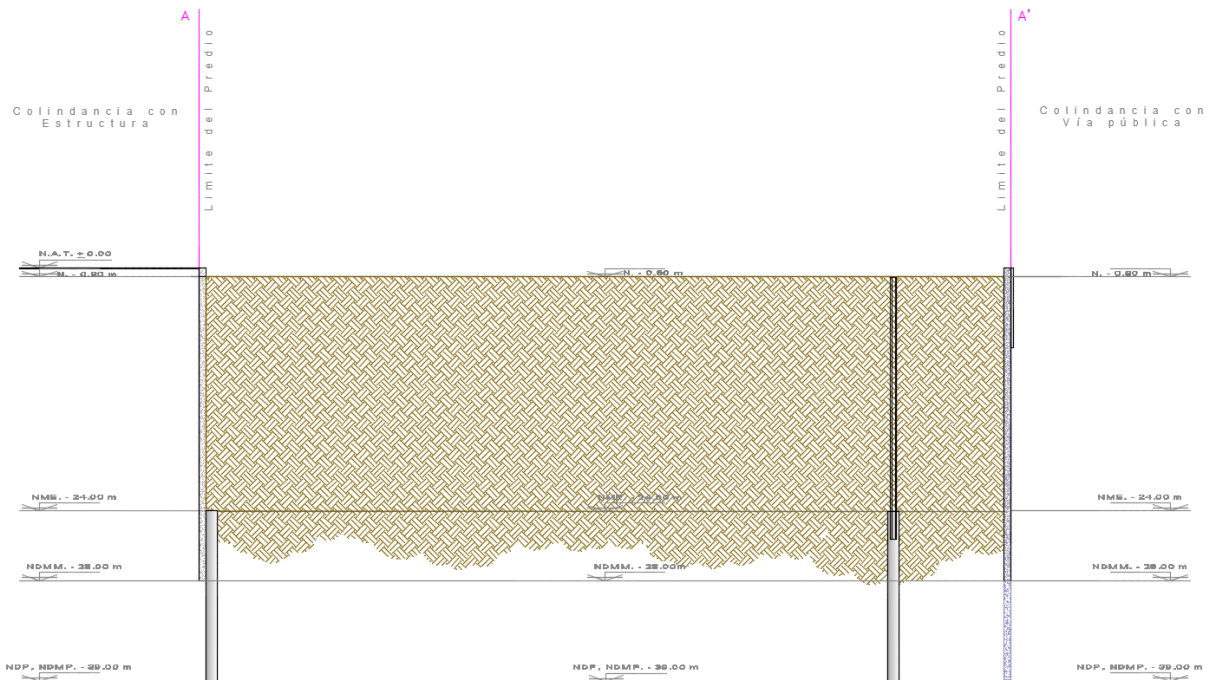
MODULACION PARA LA CONSTRUCCION DEL MURO MILAN Y MURO PILA
